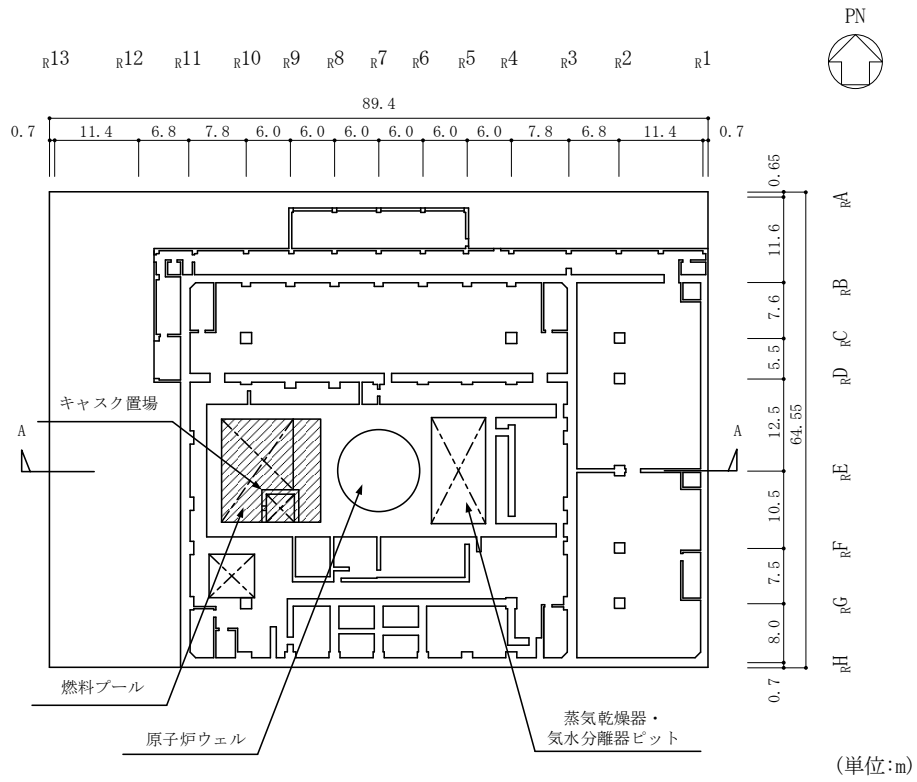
燃料プール及びキャスク置場を含む原子炉建物の概略平面図
